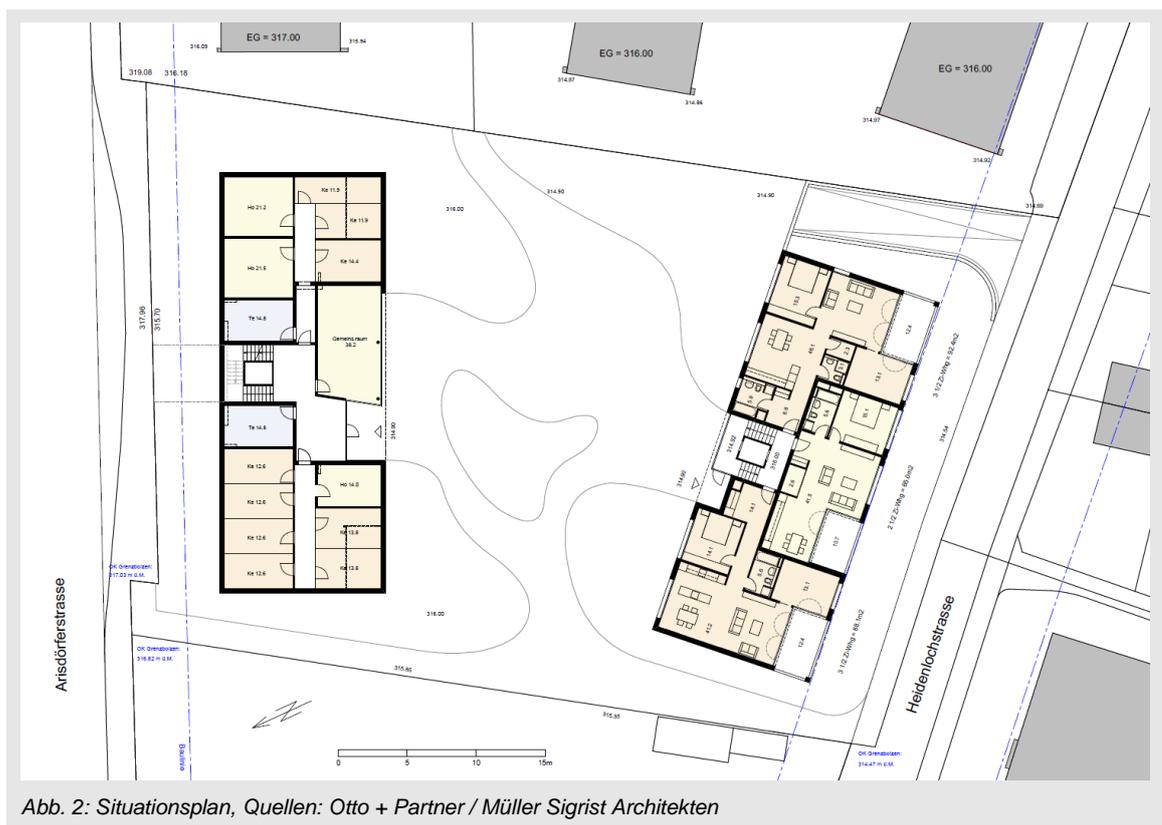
Situationsplan, Quellen: Otto + Partner / Müller Sigrüst Architekten
